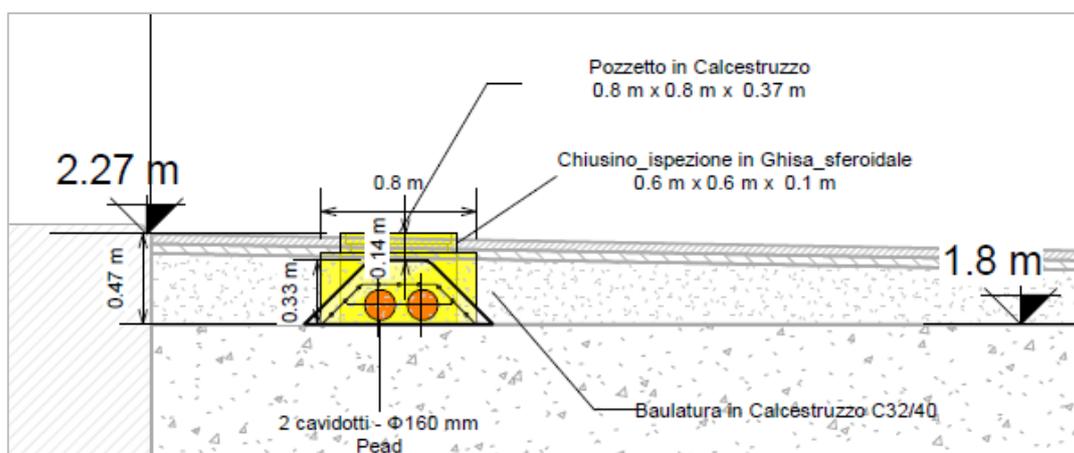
Sezione tipo predisposizione impianto elettrico
